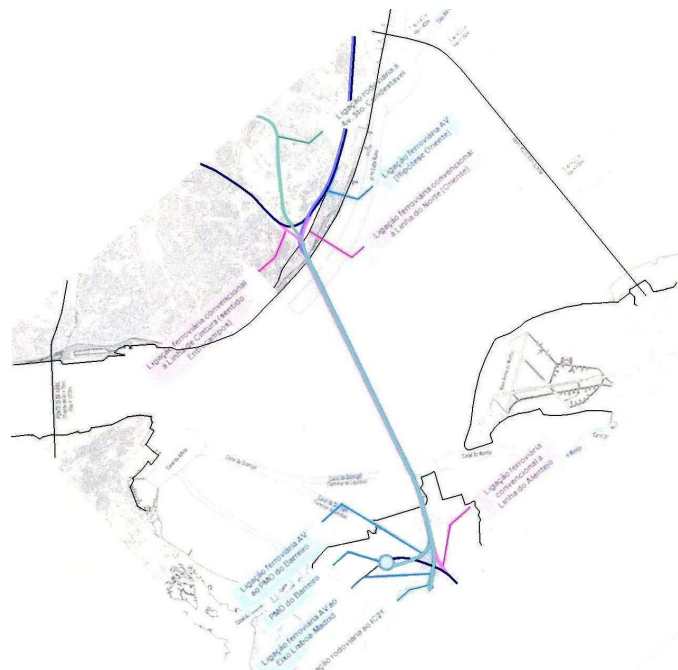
Implantação da ponte Chelas-Barreiro (RAVE)
